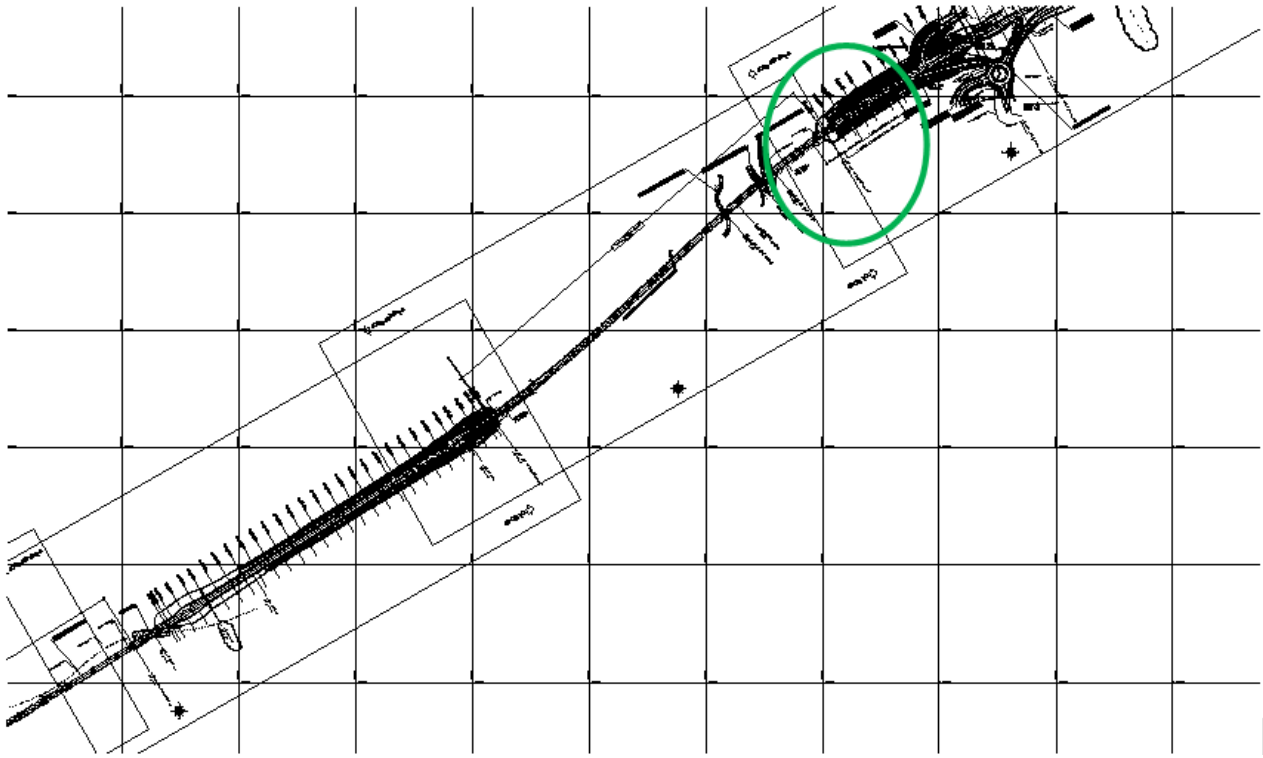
Localizzazione geografica dell'opera (Spalla 2) – Planimetria di progetto
